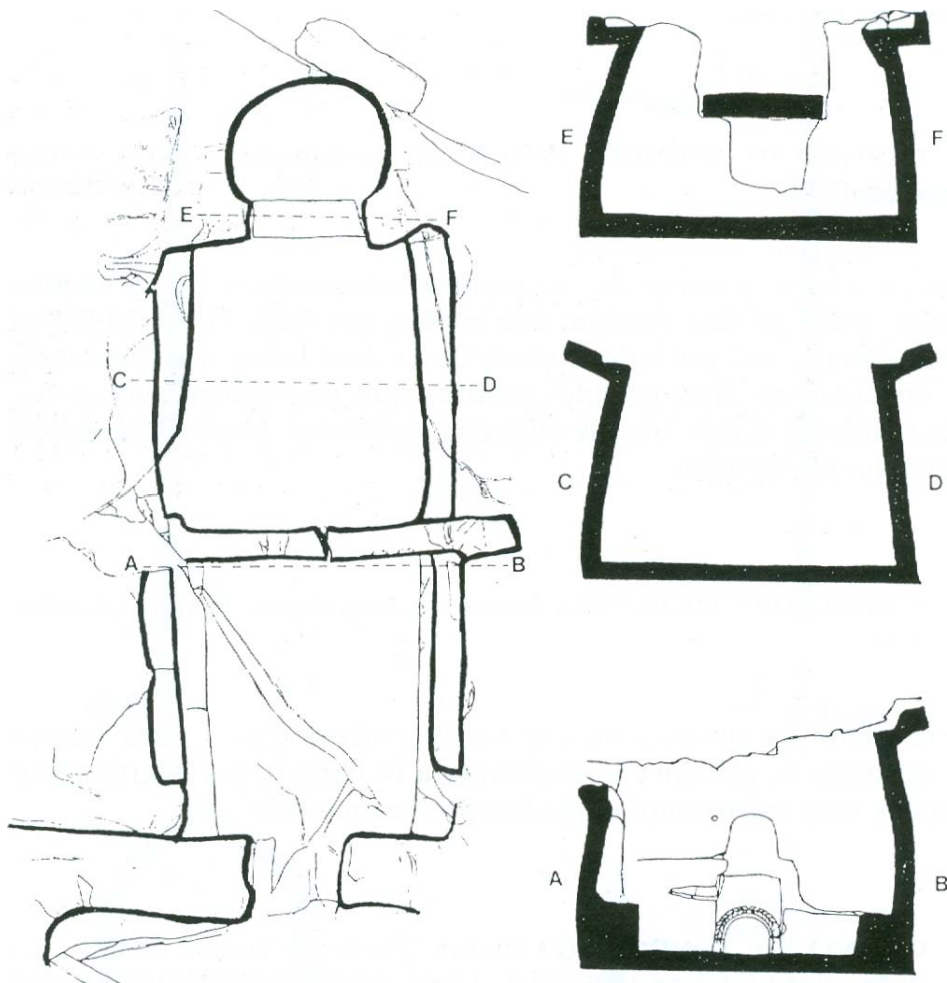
Planta y secciones de la «sauna» de Tongobriga (Silva, 1986).
